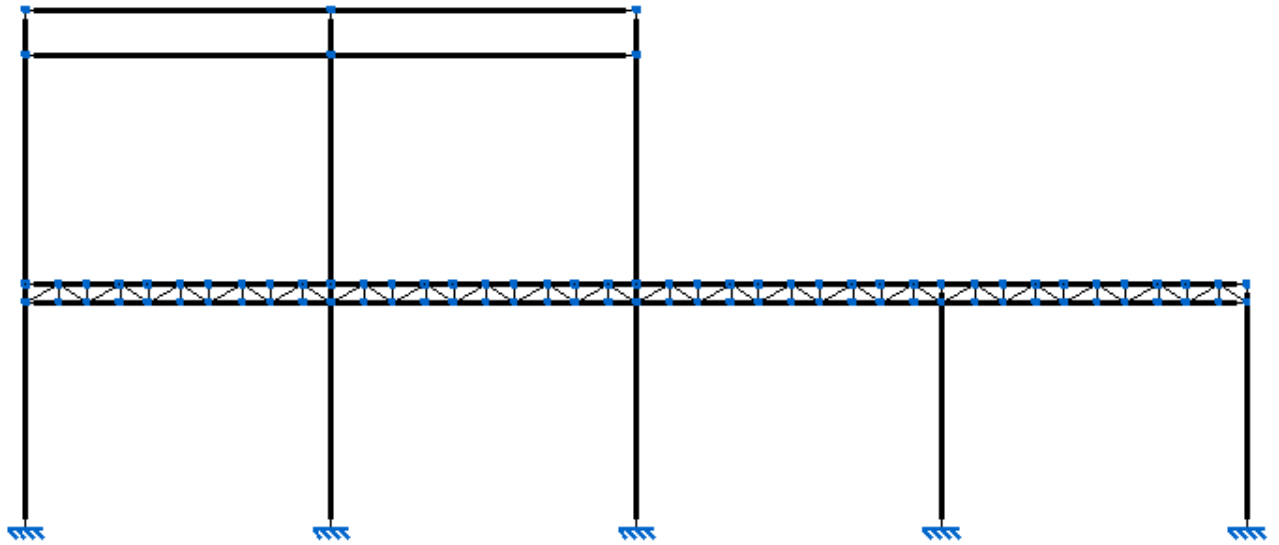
Geometría Modelo CYPE 3D – barras Vista Oeste
